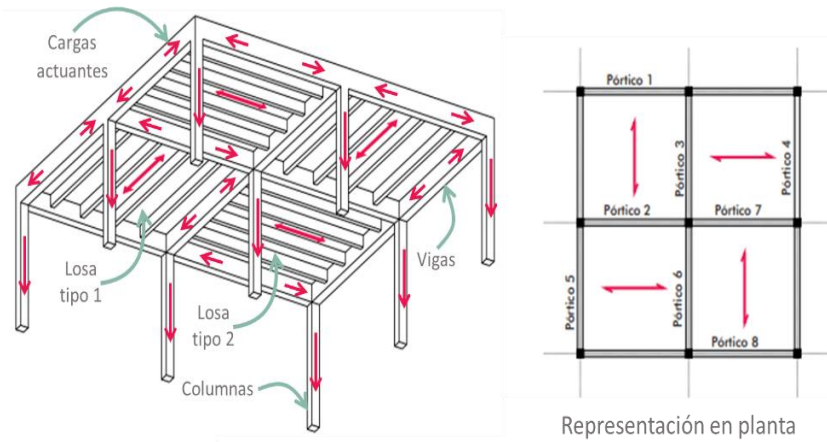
Sistemas unidireccionales sobre pórticos planos
